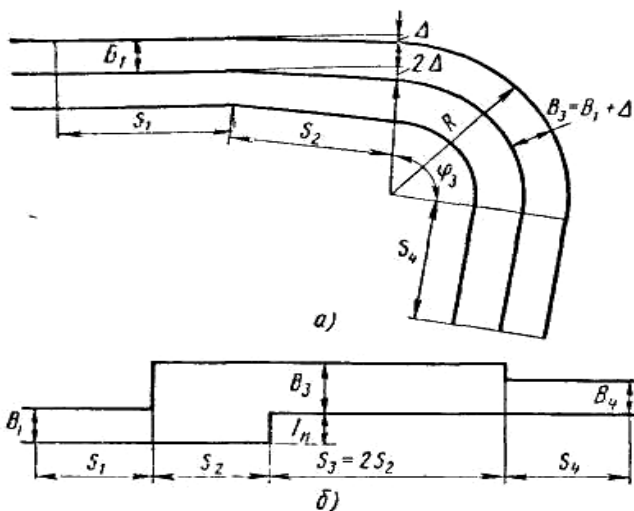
Разметка участка дороги для тормозных испытаний:
